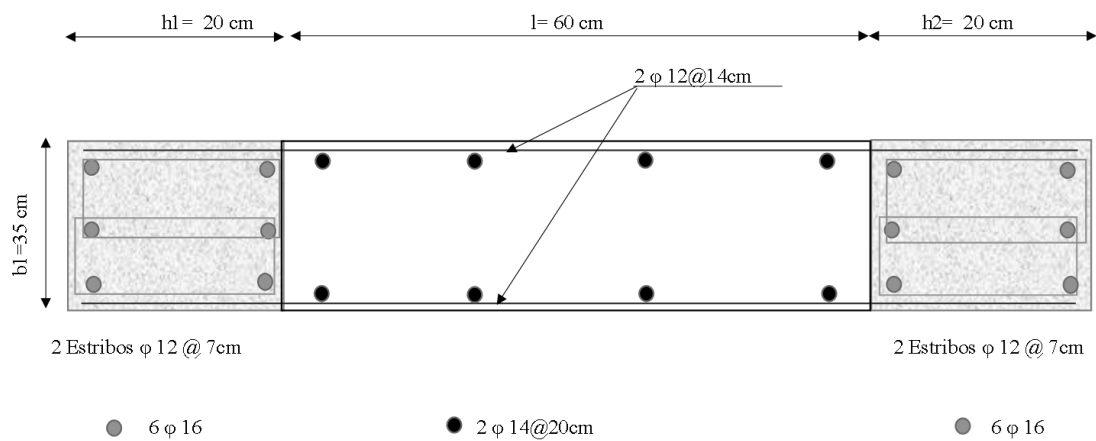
Armado del muro correspondiente a la geometría 3 en base al FBD
